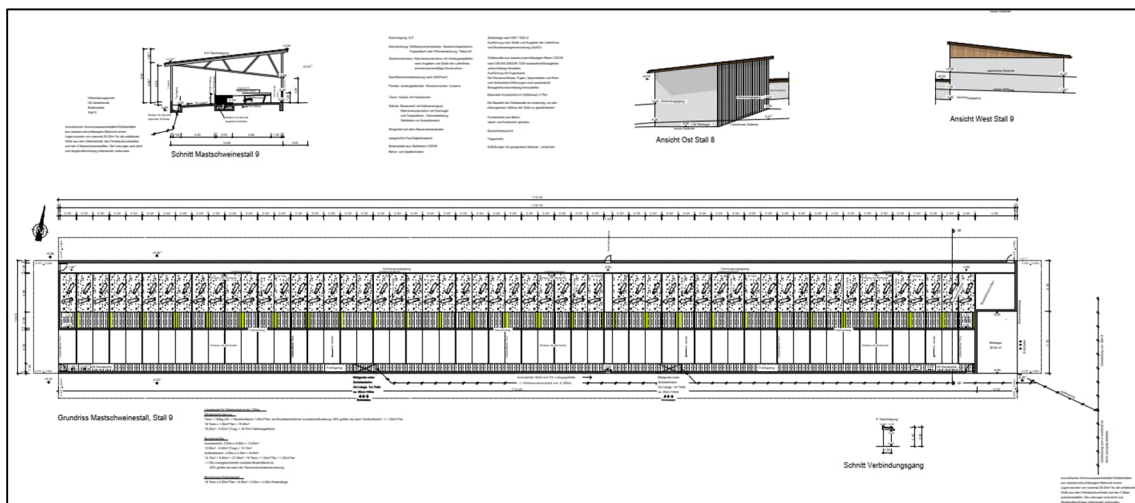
Grundriss und Schnitt von Stall 9 (Quelle: BBV Landsiedlung GmbH)
